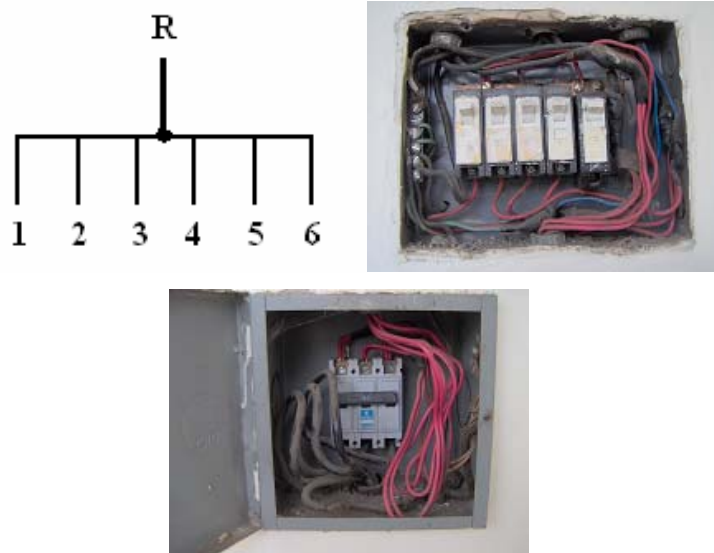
Tablero de uso final TF3 y protección tripolar de 60A
